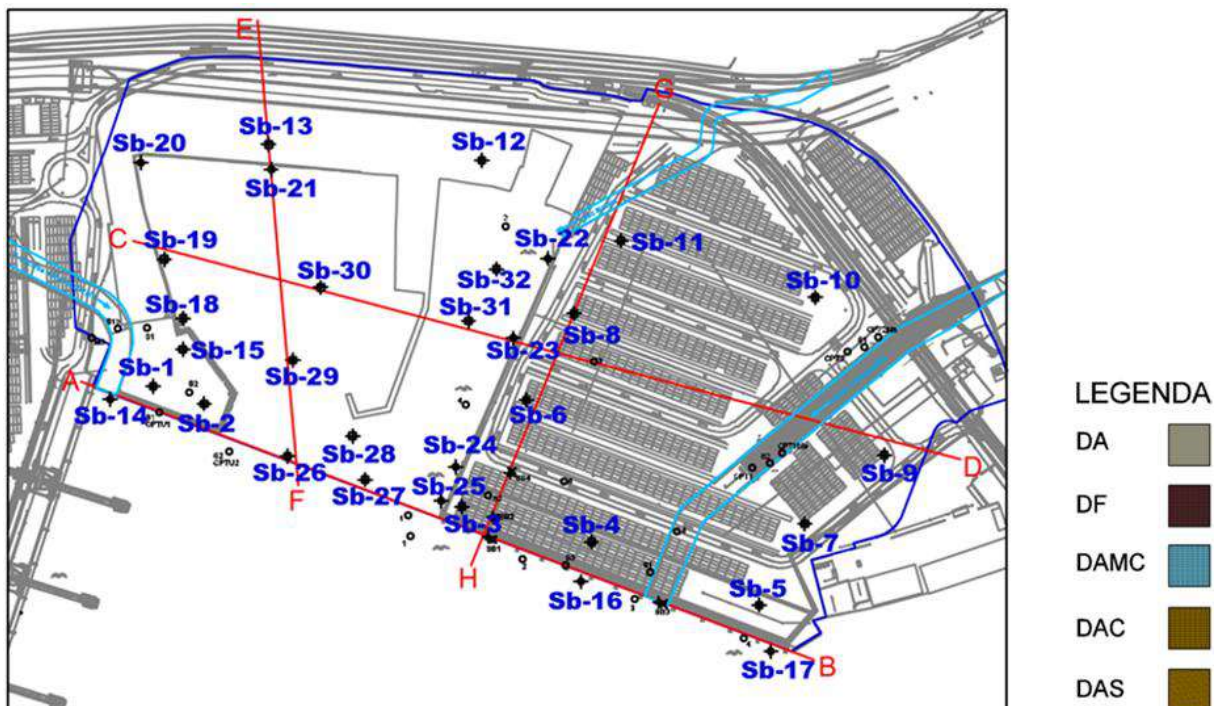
Planimetria dell'area di intervento e traccia delle sezioni stratigrafiche
